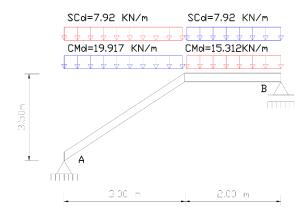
Consideración de la escalera para el cálculo de la armadura principal.
